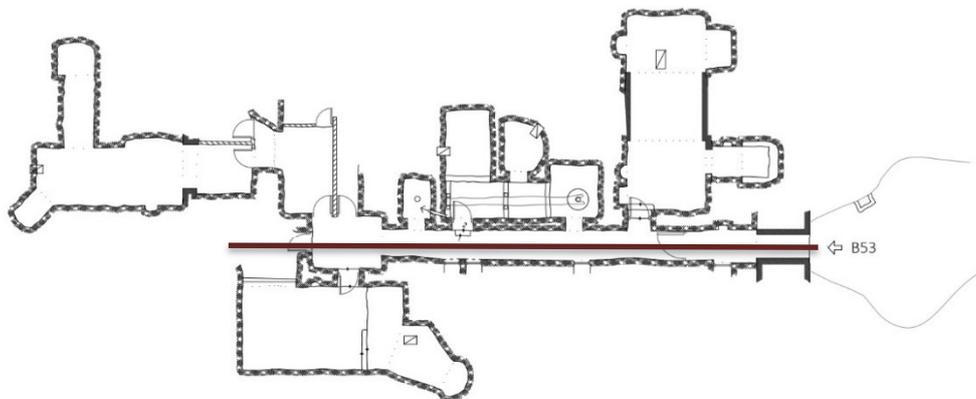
Planta bodega SRH_B53. Escala: 1/400. Fuente: *Elaboración del autor.
